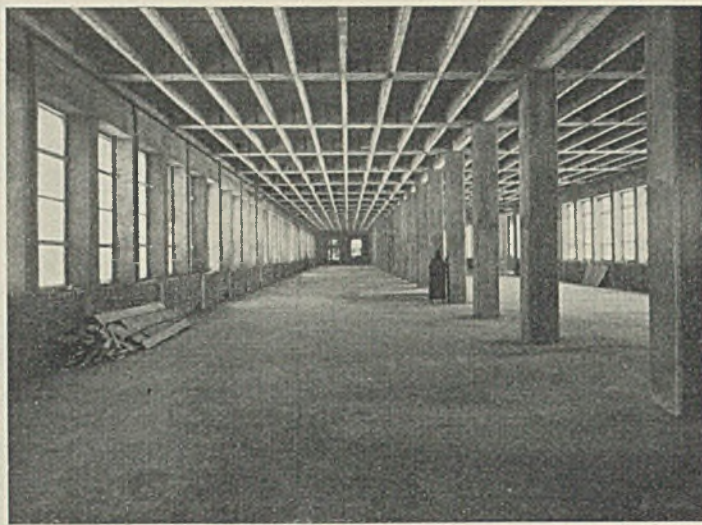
Ansicht der Bimsbetondecke ohne Putzdecke.
